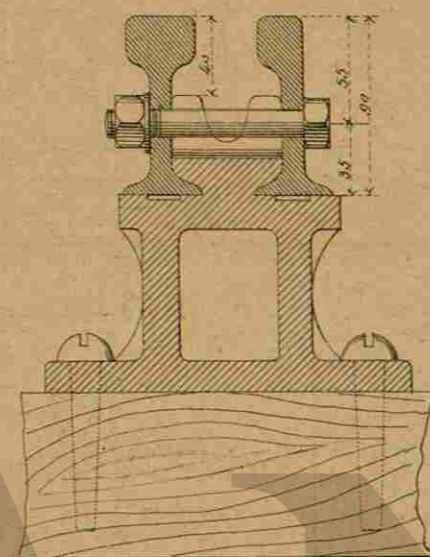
Coupe long<sup>e</sup> au droit d'un coussinet
